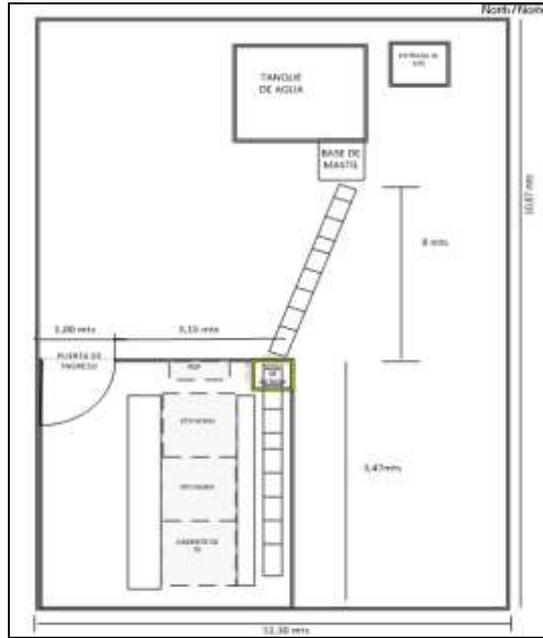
Plano – Vista aérea de la planta del inmueble donde se ubica el sitio.
